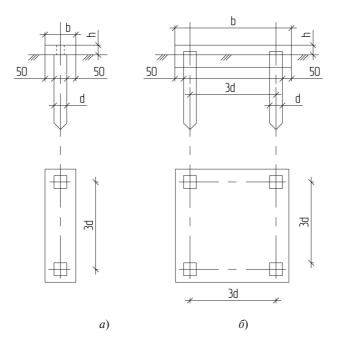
Конструкции свайных ленточных фундаментов: a — однорядное размещение свай с жестким сопряжением;  $\delta$  — двухрядное размещение свай с шарнирным сопряжением
